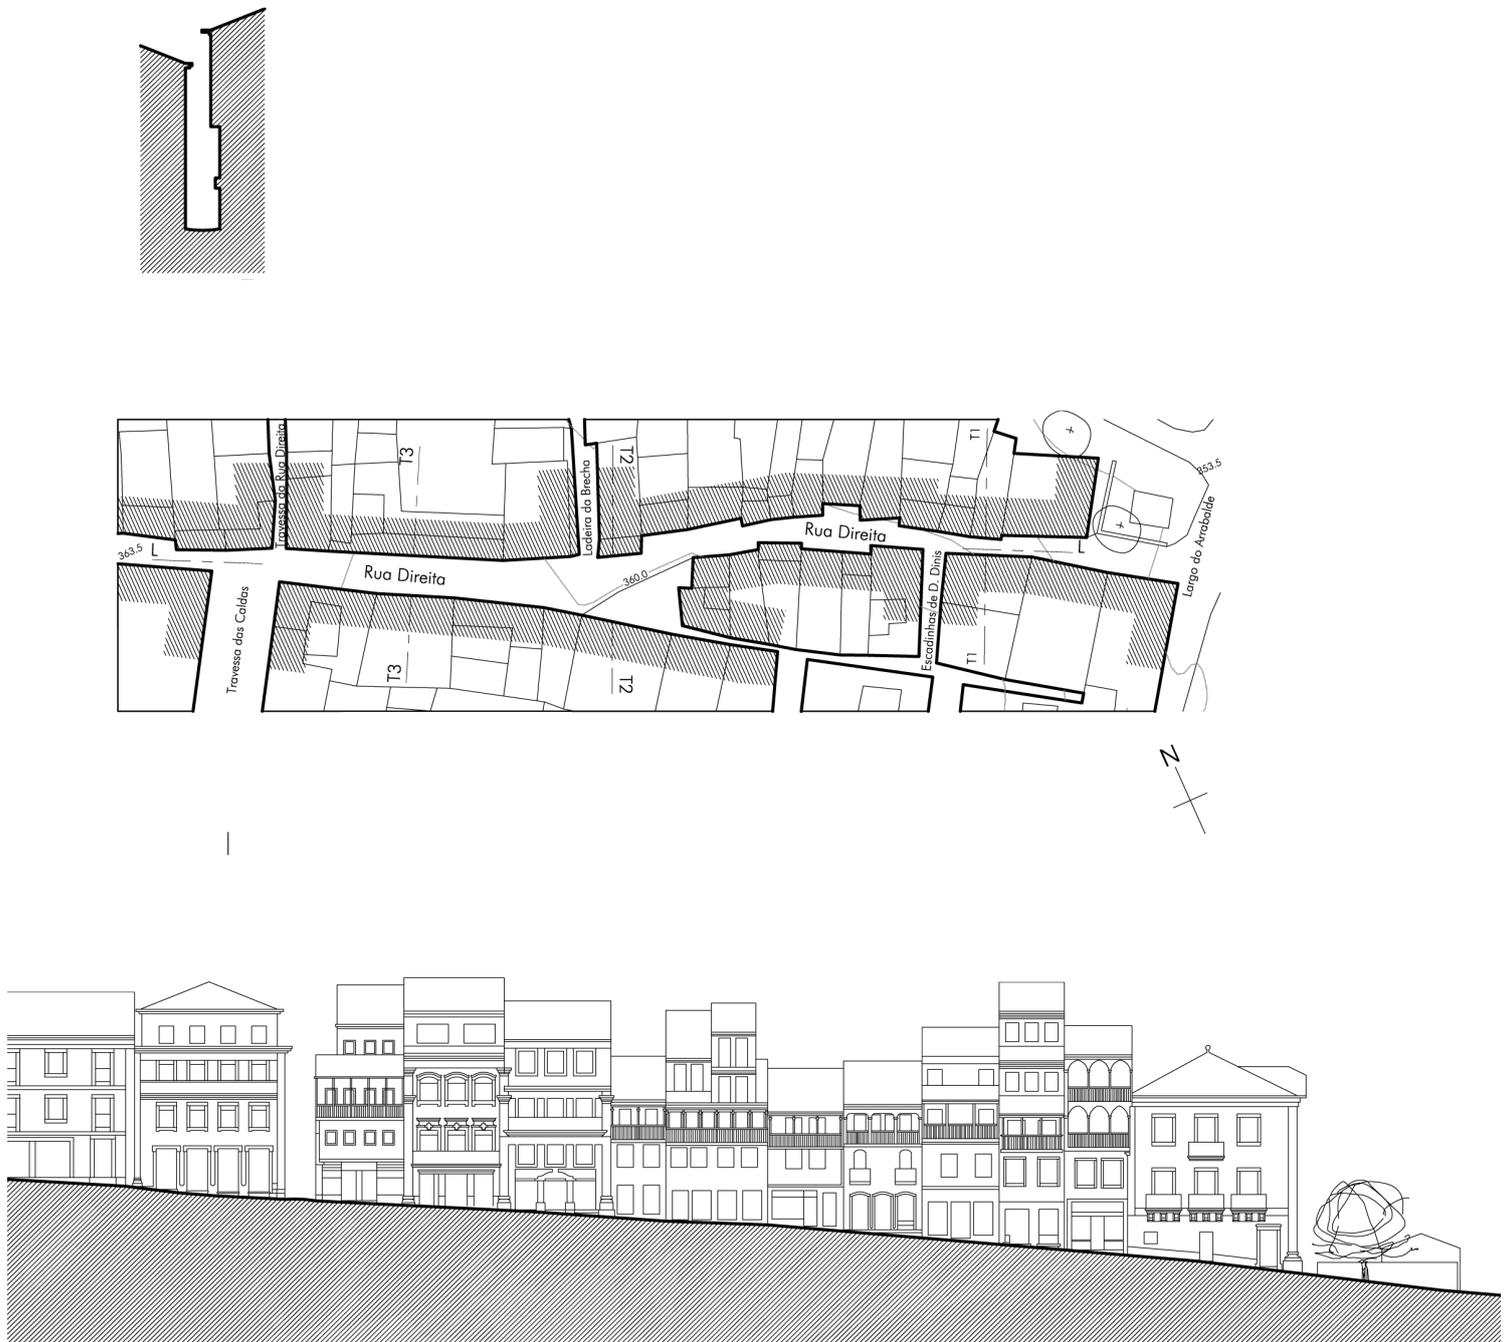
| Perfil Transversal Tipo, Planta; Perfil Longitudinal de um troço da Rua
